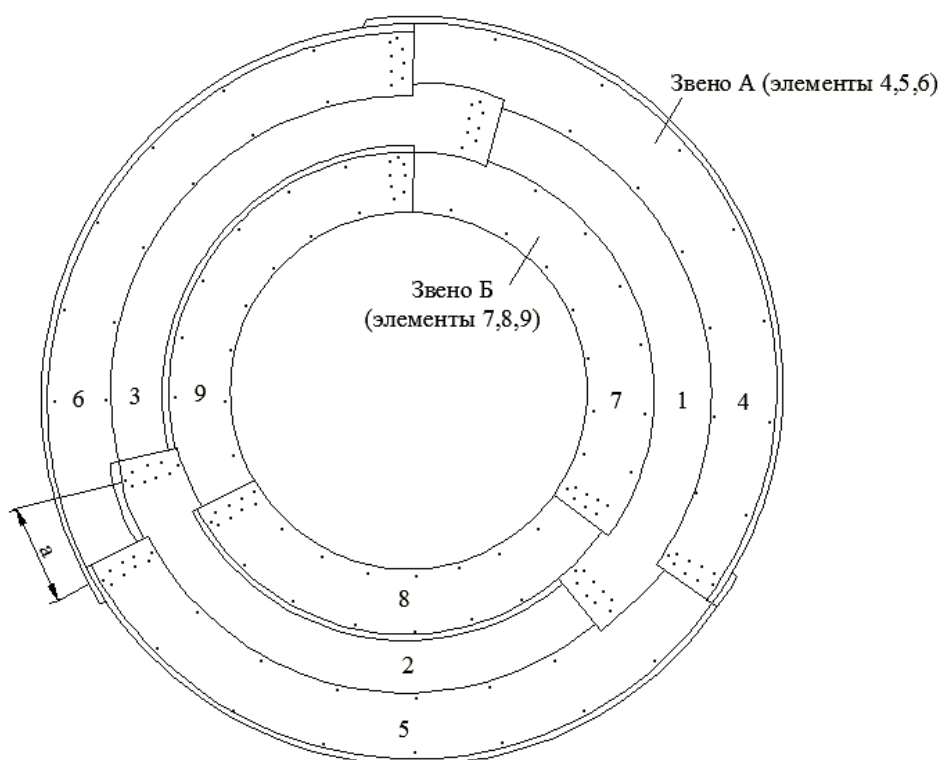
Монтажная схема сборки секции трубы из звеньев (вид с торца):  $a$  – величина сдвижки продольных стыков; 1–9 – порядок установки элементов при сборке трубы
